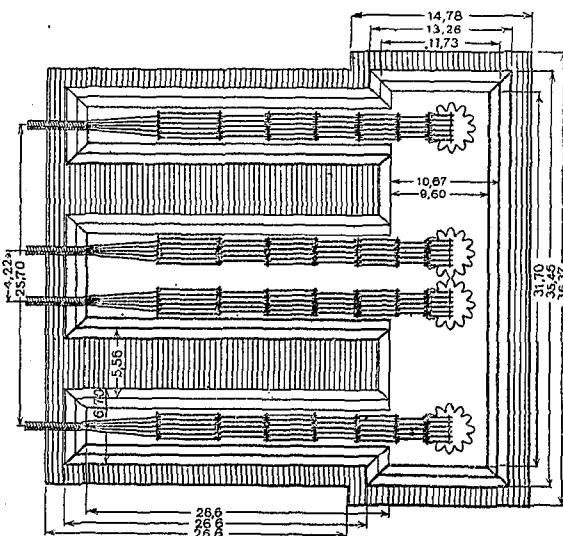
Kabel-Verankerung (Grundriss).
